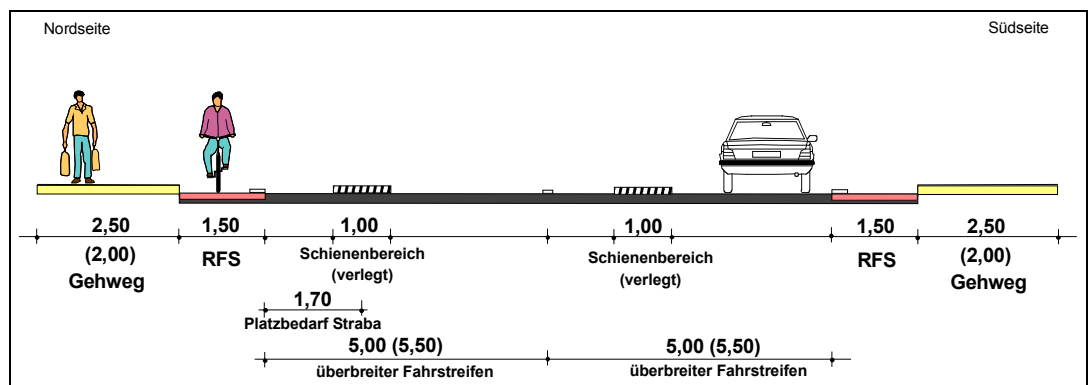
Abschnitt 2 – Längerfristige Planung
